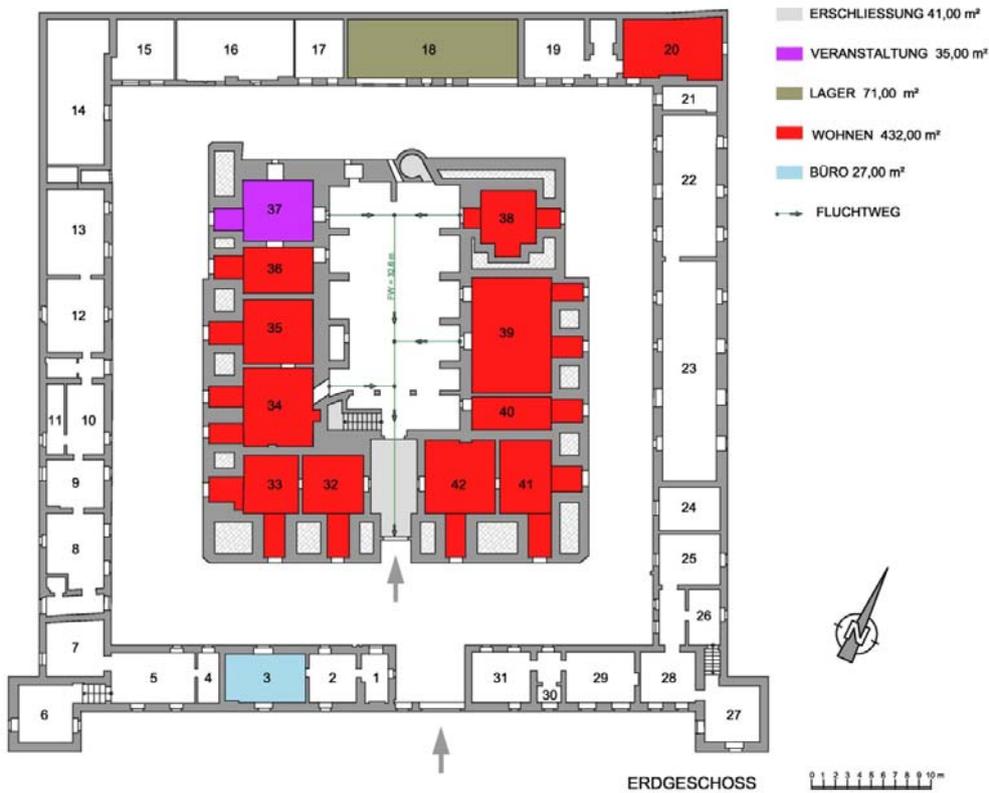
zeigt den Grundriss des Schlosses Bockfließ
